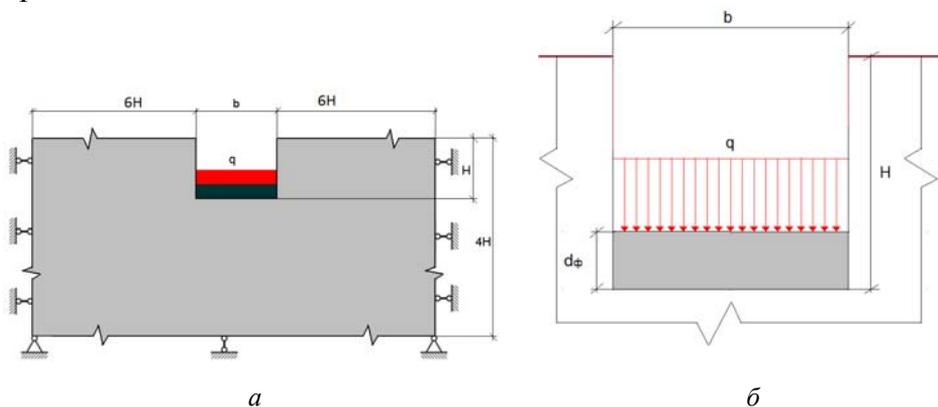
Геометрические размеры механико-математической модели основания заглубленного фундамента конечной жесткости (нагрузка передается через штамп) (а) и фрагмент расчетной схемы (б)
